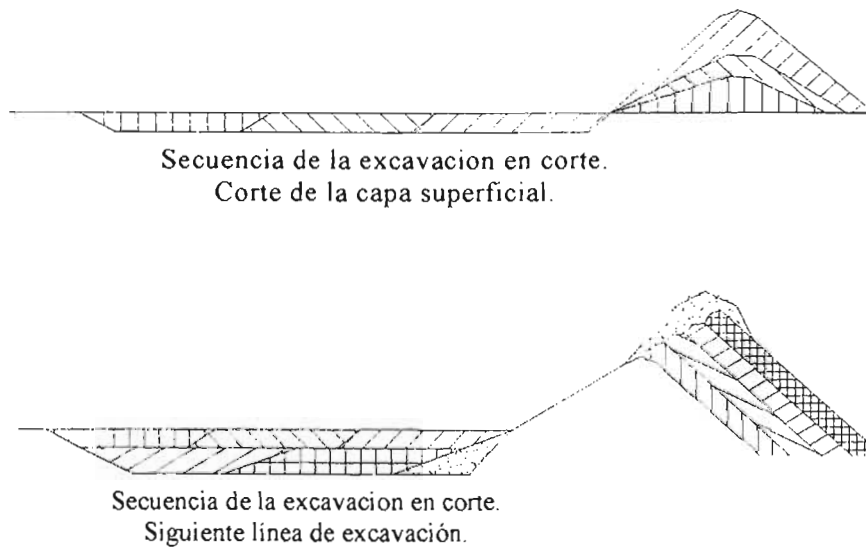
Secuencia de la Excavación con Bulldozer (Elevación).
